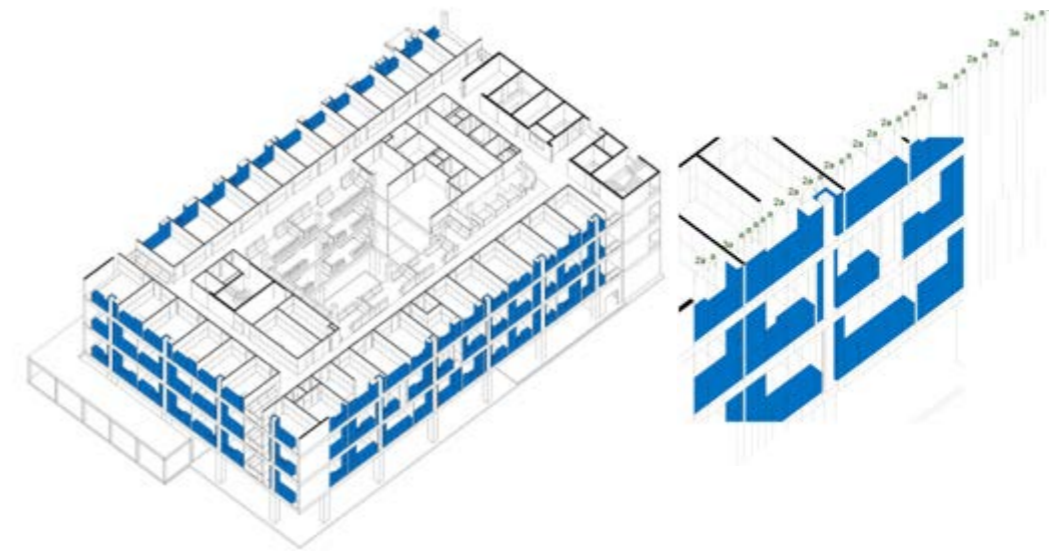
Les équipements « fixes », modulaires et entièrement démontables, sont placés le long de la façade. (détail à droite) (Source : archipelago architects)
